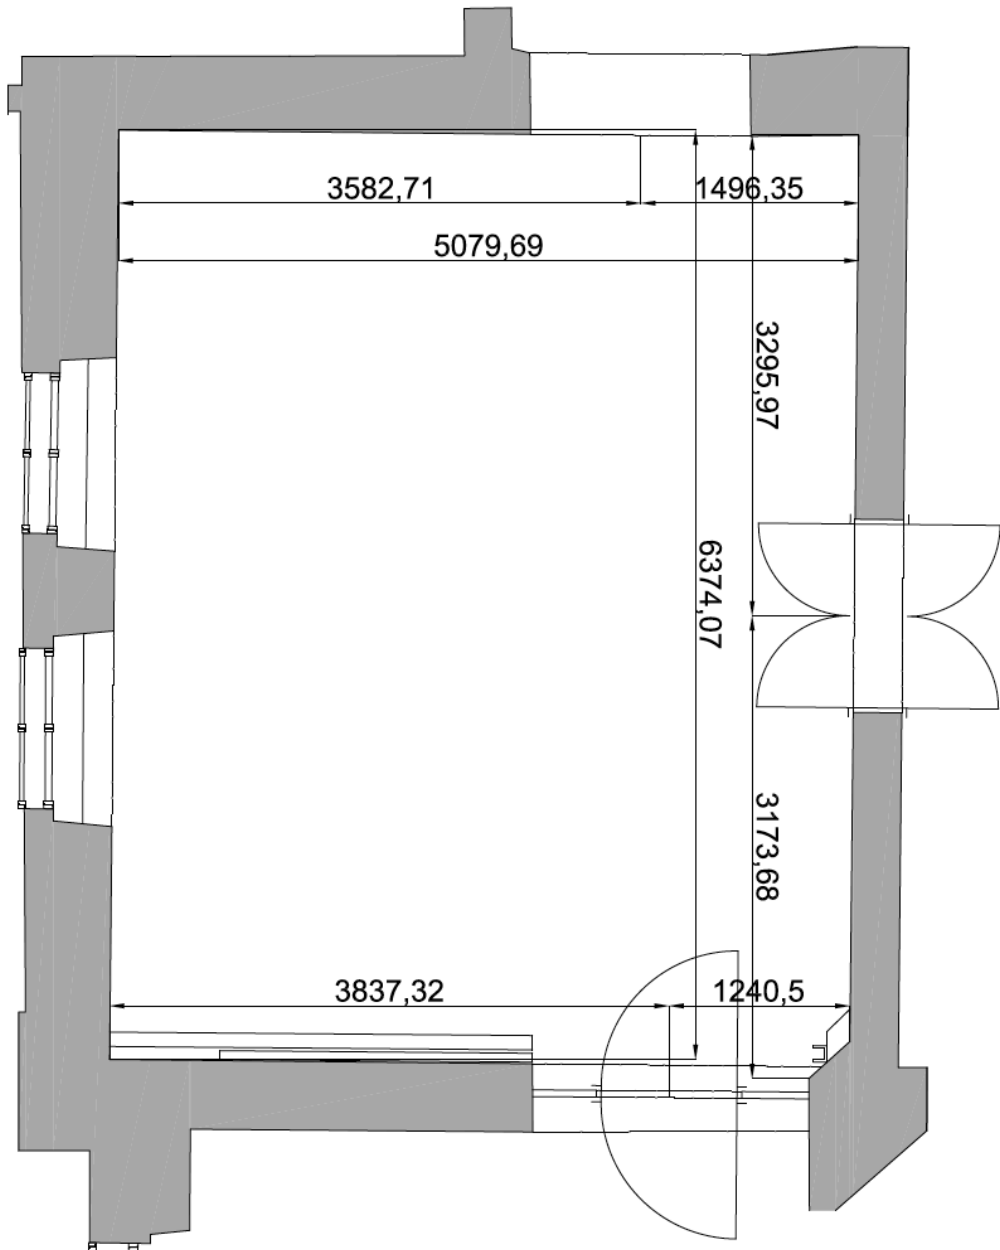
Grundriss vom Meeting Point
